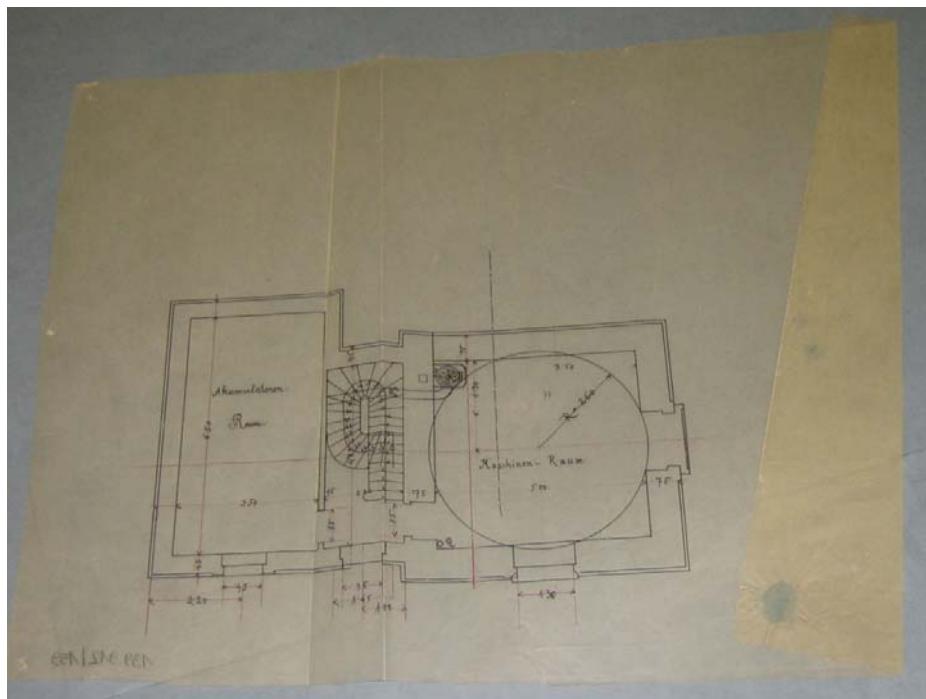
Pumpenhaus der Villa Schoeller Grundriss
